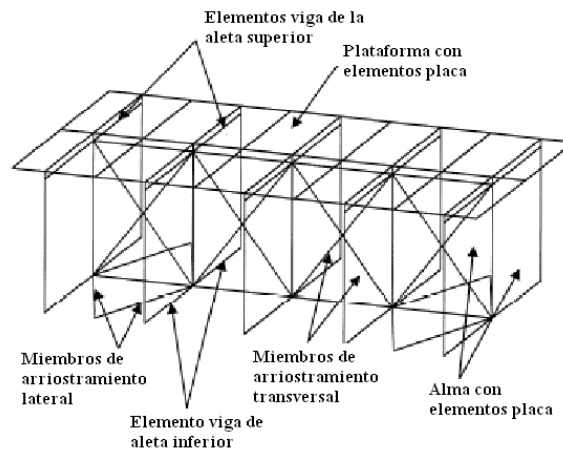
Ejemplo de modelado de una superestructura de vigas.
